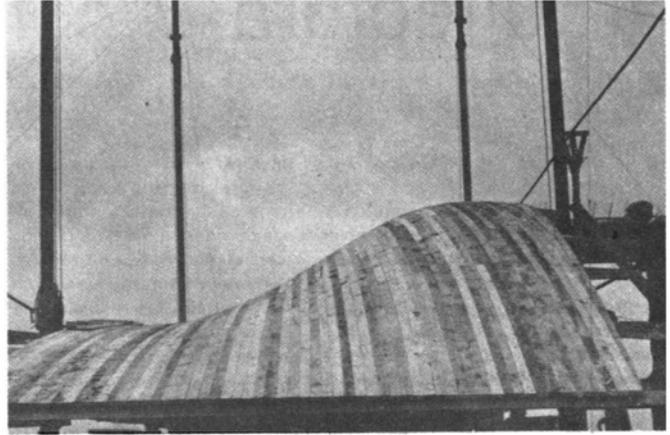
Encofrado de madera del cascarón anterior, montado sobre la estructura que le permite deslizarse.
